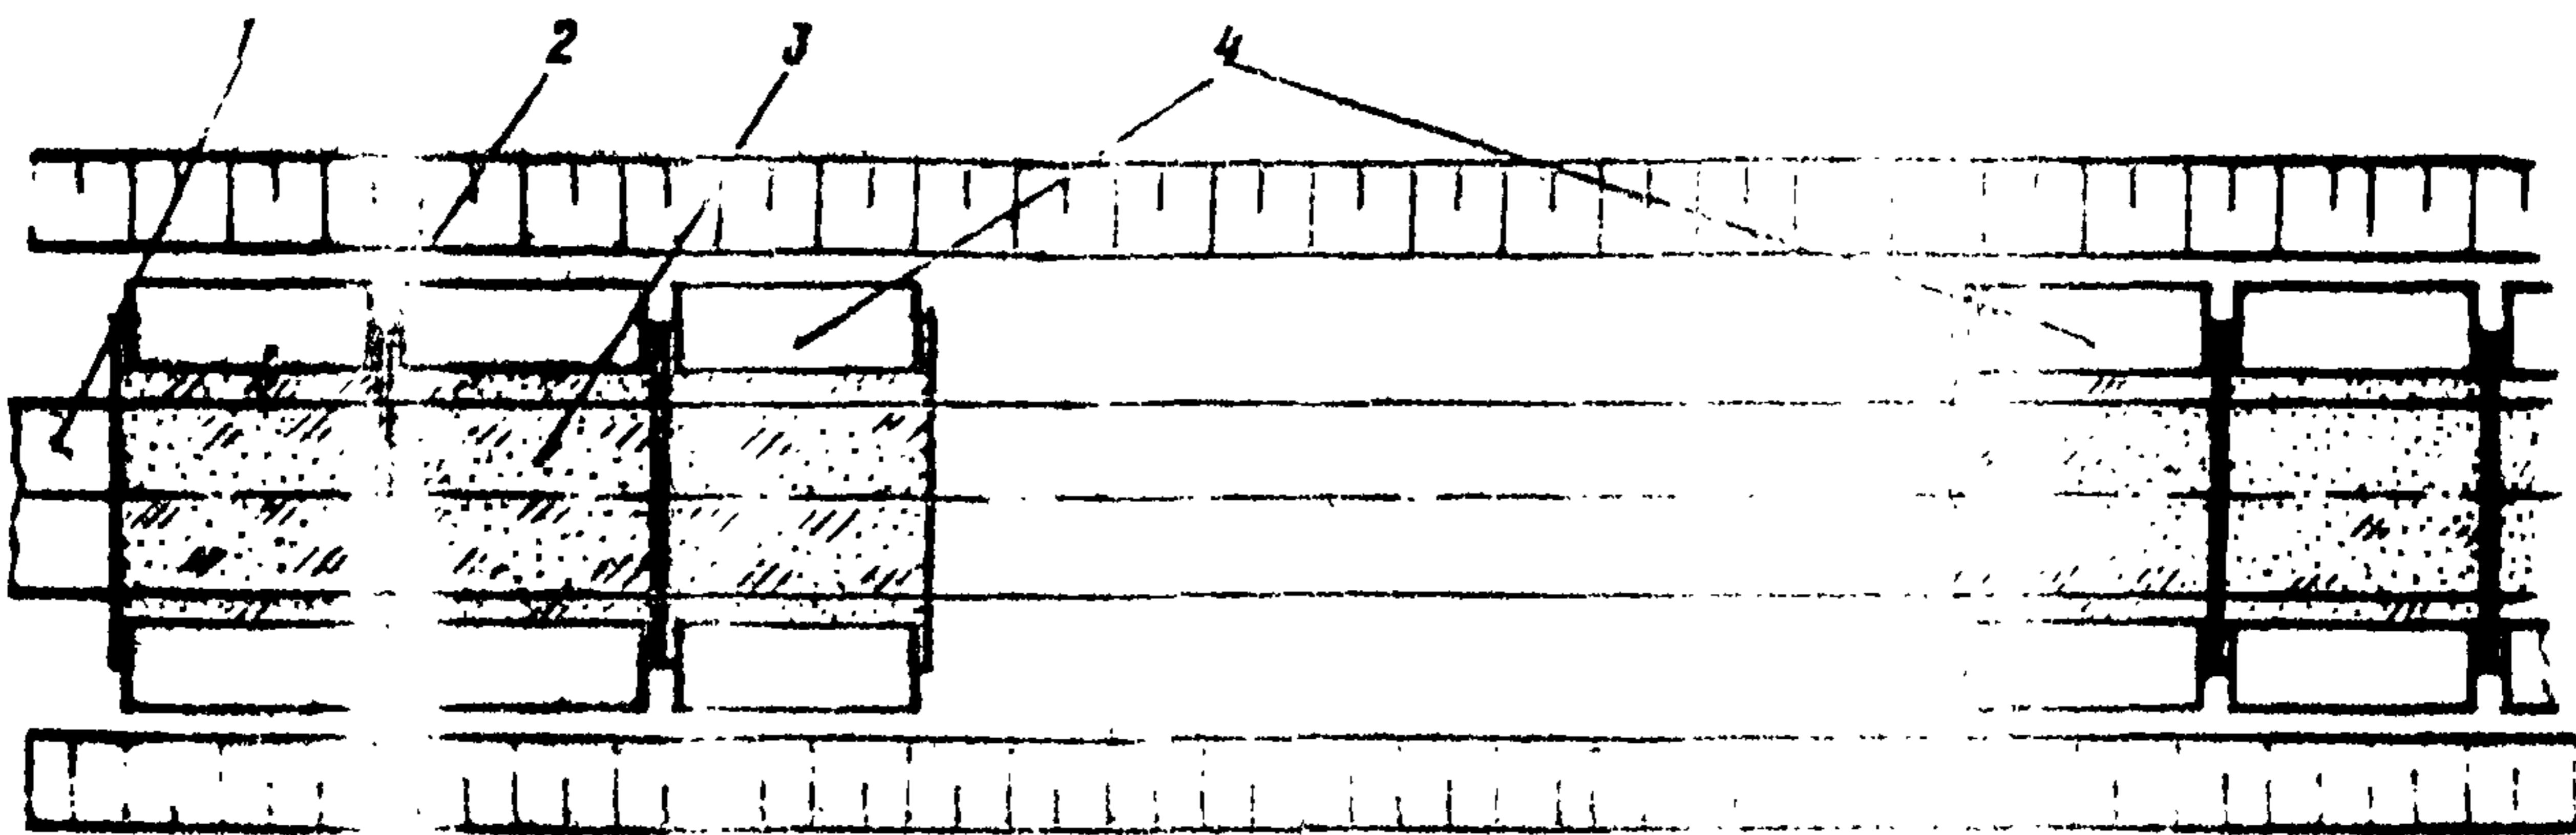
Грунтовый метод выравнивания трубопроводов с прямым земляным покрытием:
